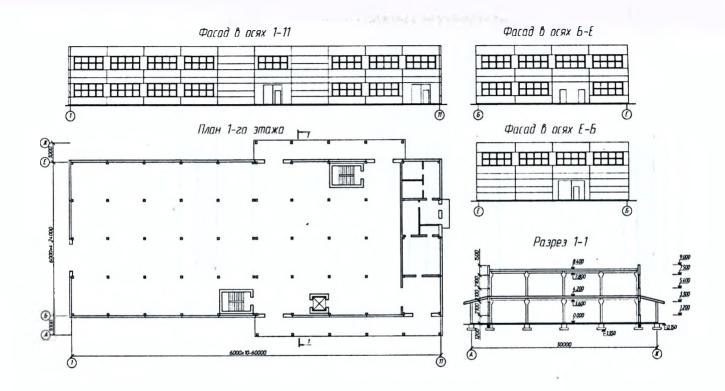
ІІ вариант – план, разрез, фасады
